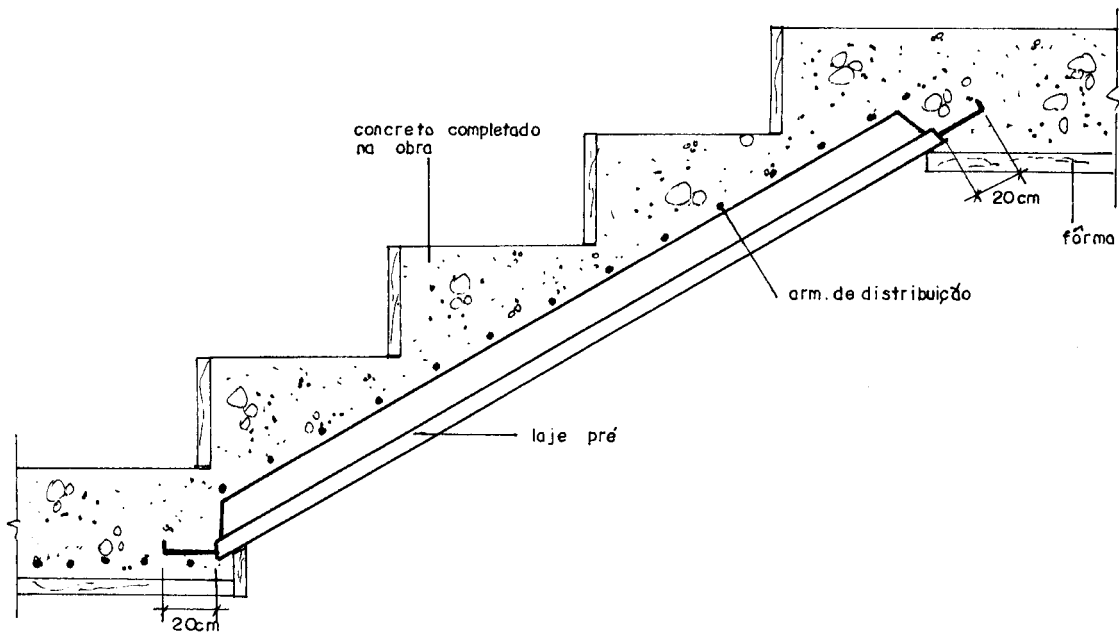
Degraus em concreto utilizando laje pré moldada
